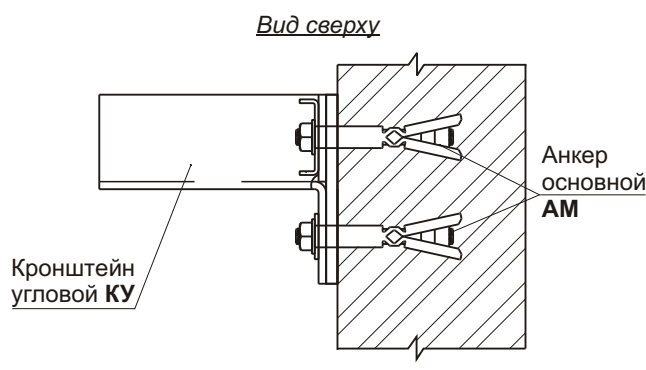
Крепление кронштейна КУ к стене двумя основными анкерами
